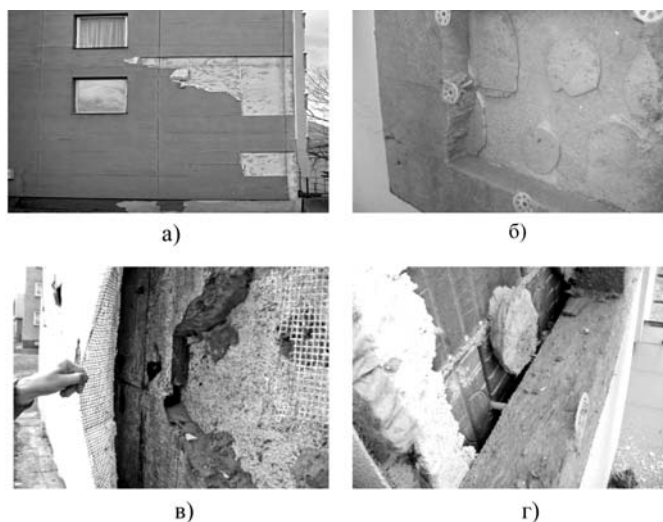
Фрагменты разрушенной теплоизоляции» на фасадах жилых зданий, утепленных минераловатными плитами
